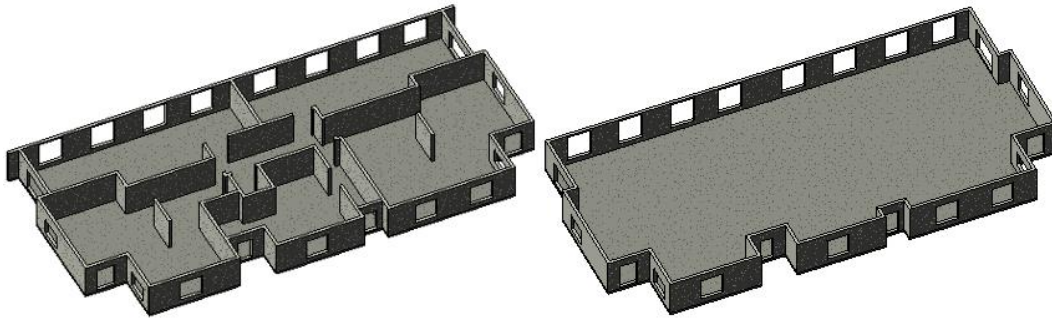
links Geschoss vor Umbau, rechts Geschoss nach Umbau
